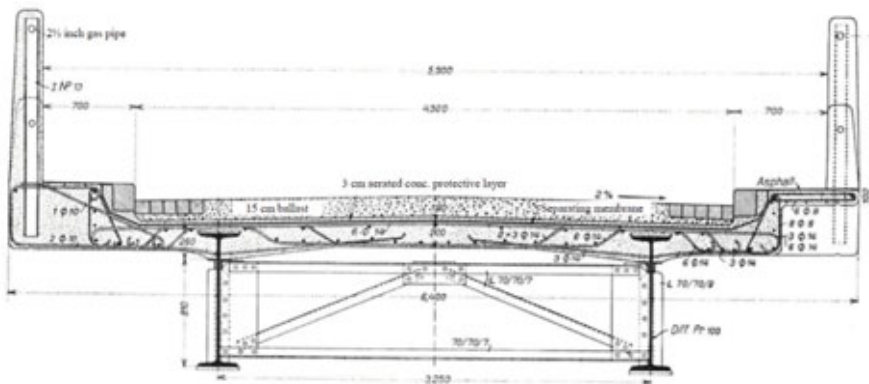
| Sezione trasversale dell'Acheregg Bridge sul Lago di Lucerna, 1914 [1]
